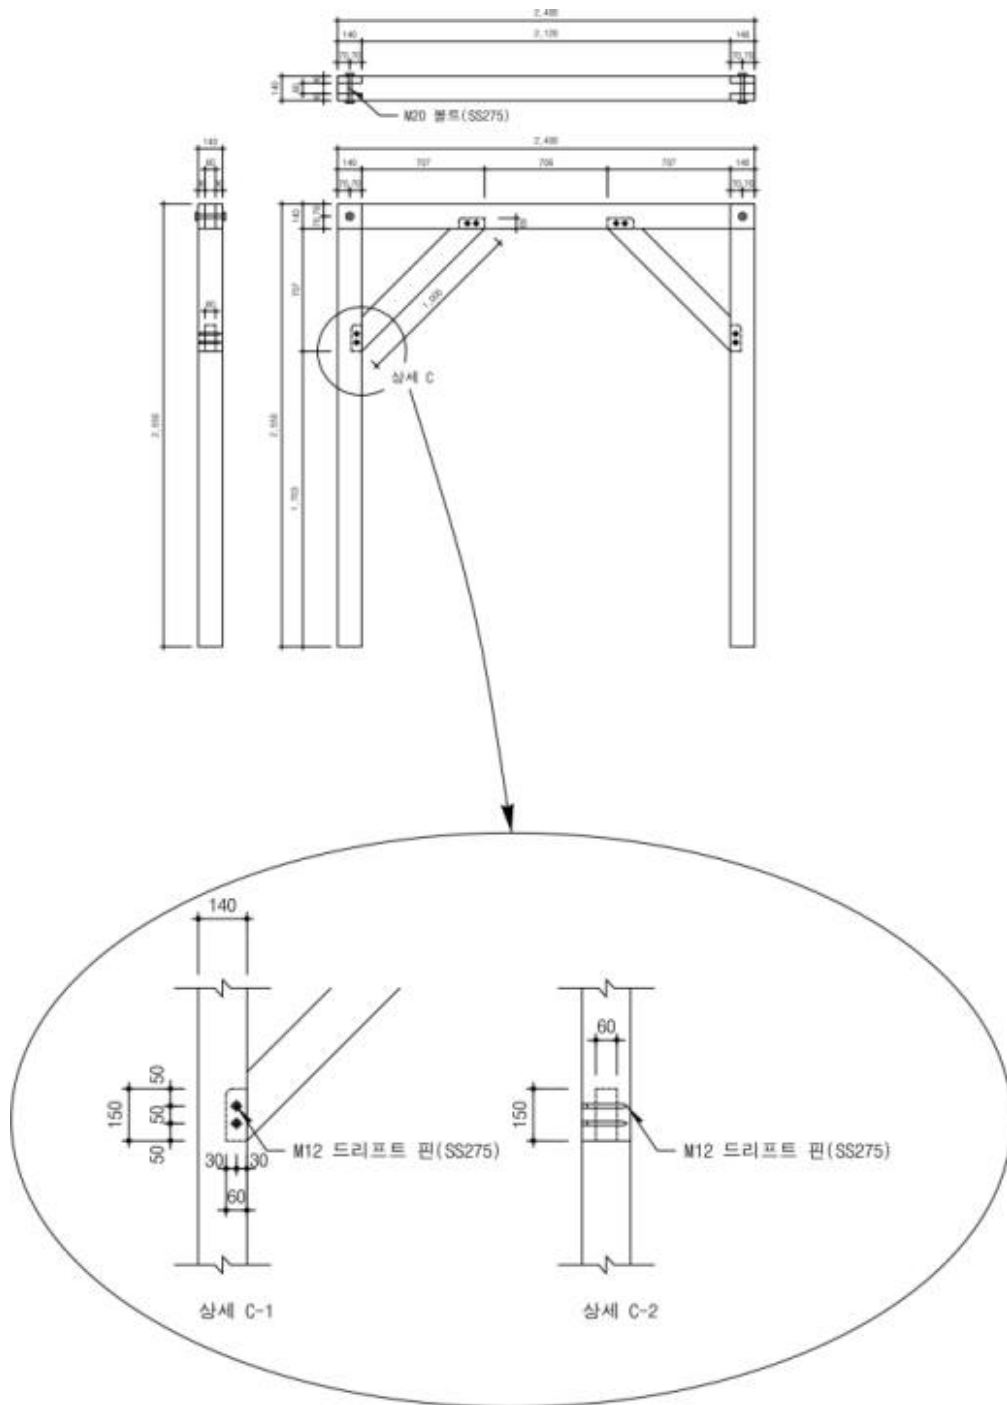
목재가새-드리프트핀 접합부(단위: mm)
